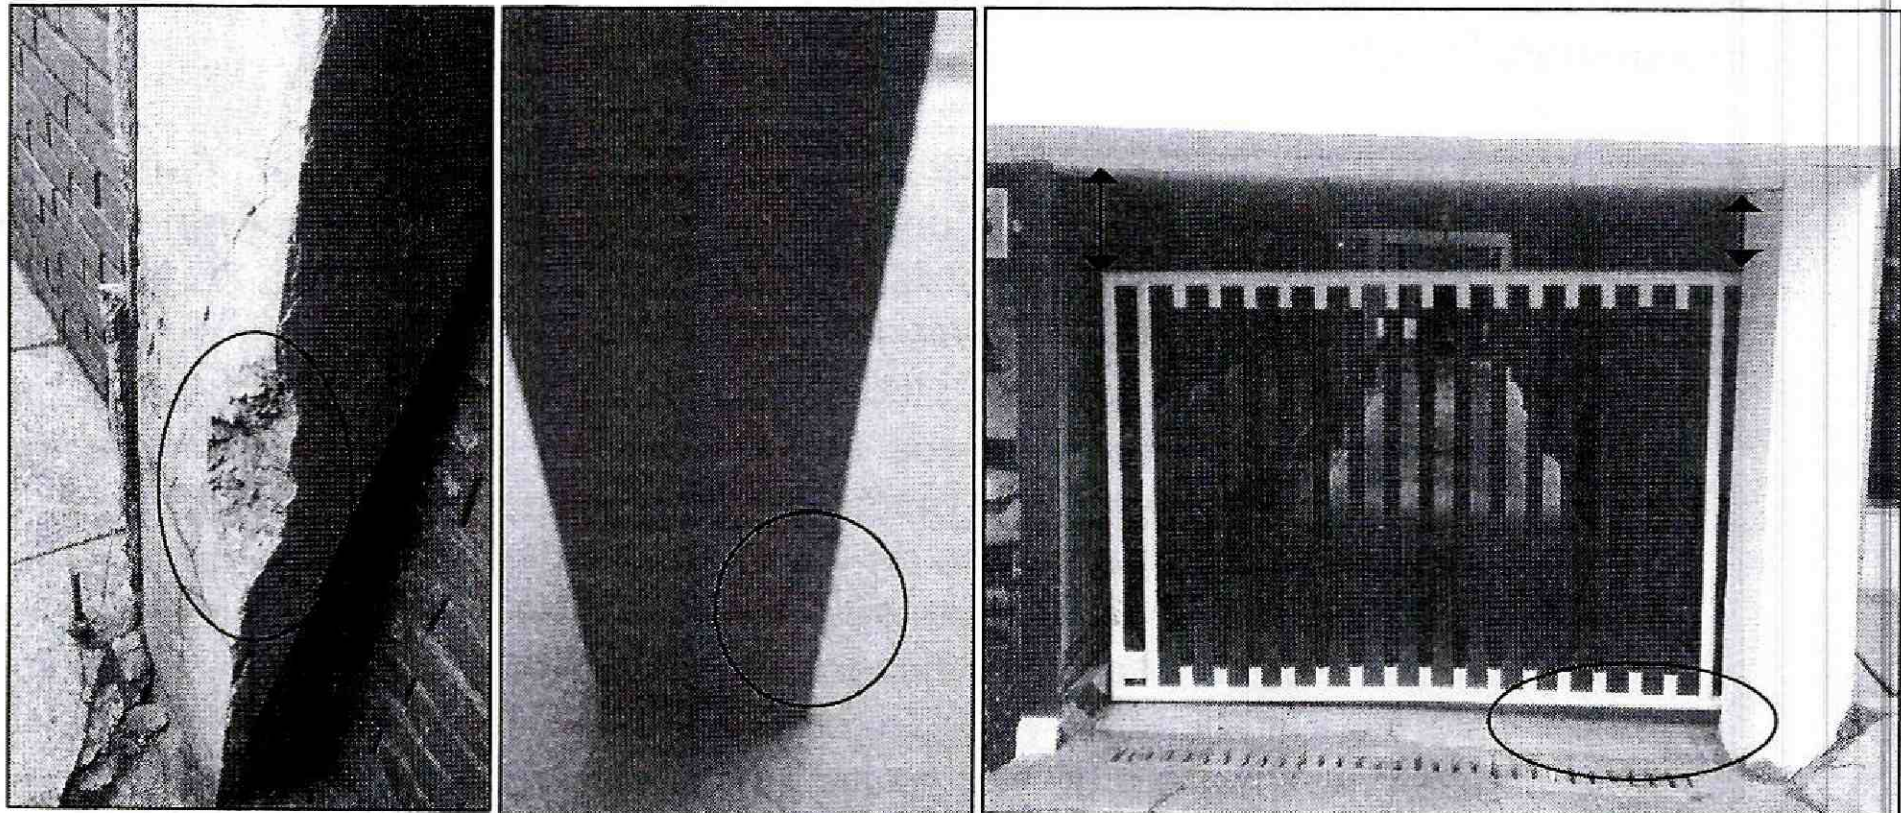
y 21. Vista de las grietas de tendencia horizontal y diagonal en muros perimetrales del primer nivel en el edificio de la Calle 85 No. 12-10
